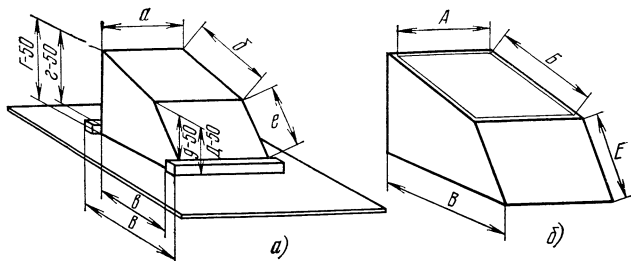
Опалубка для изготовления цельных железобетонных угловых вставок к типовым колодцам кабельной канализации:
